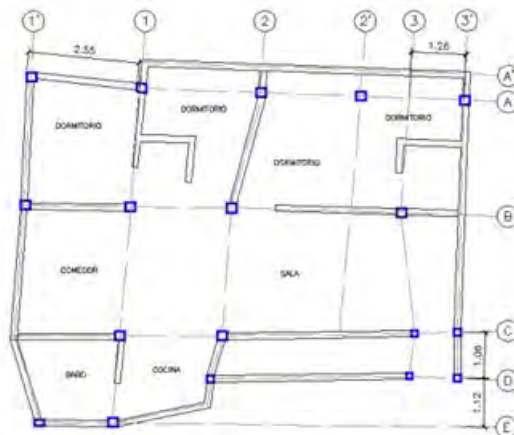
Detalles indicativos de deficiencias constructivas de la vivienda.
